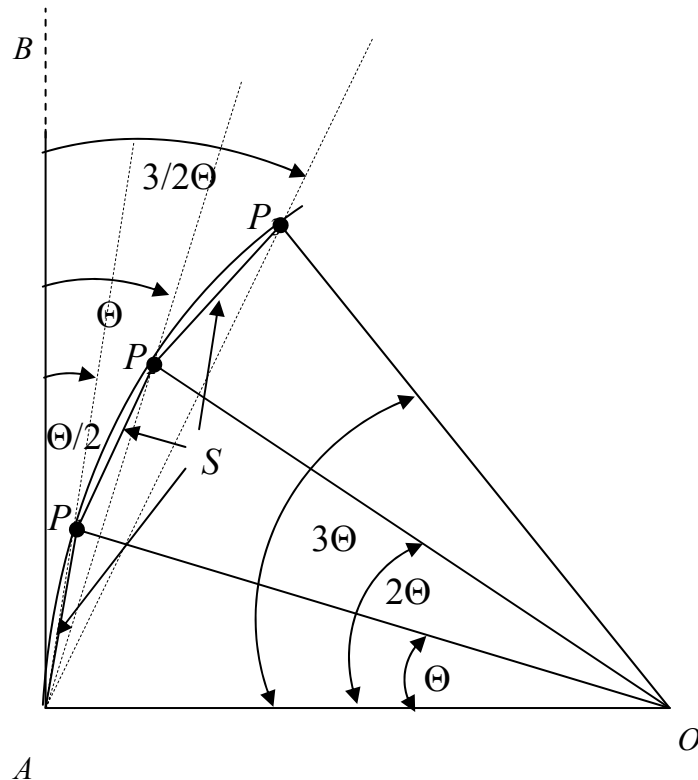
Схема детальной разбивки кривой способом полярных координат
